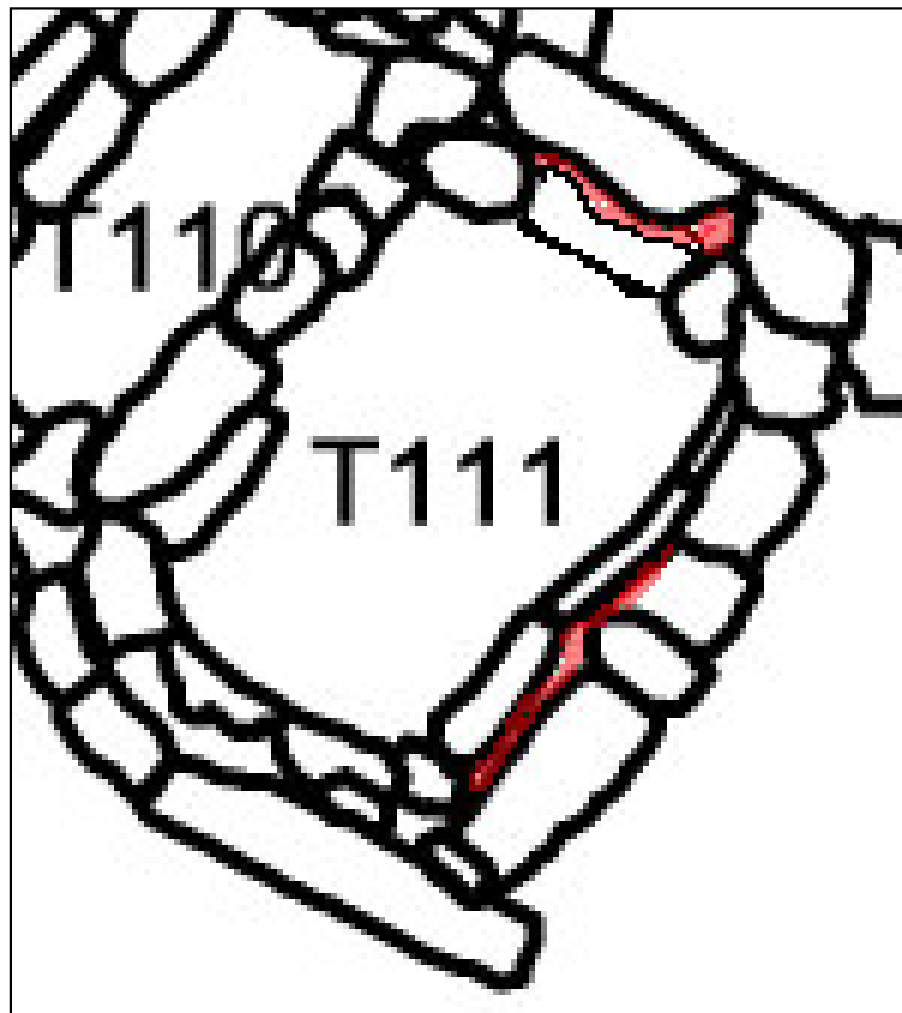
Planta de les intervencions, en vermell els murs intervinguts.
